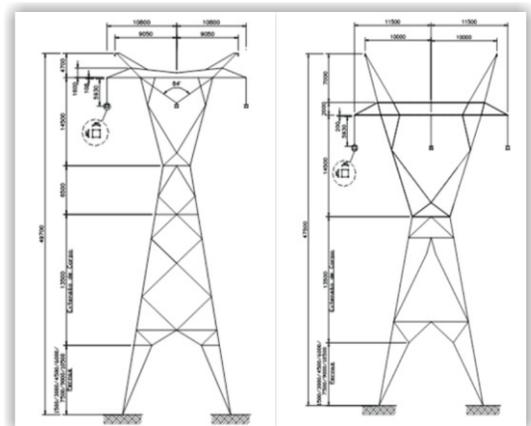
Tipos de torres metálicas para LT de 525 kV.
